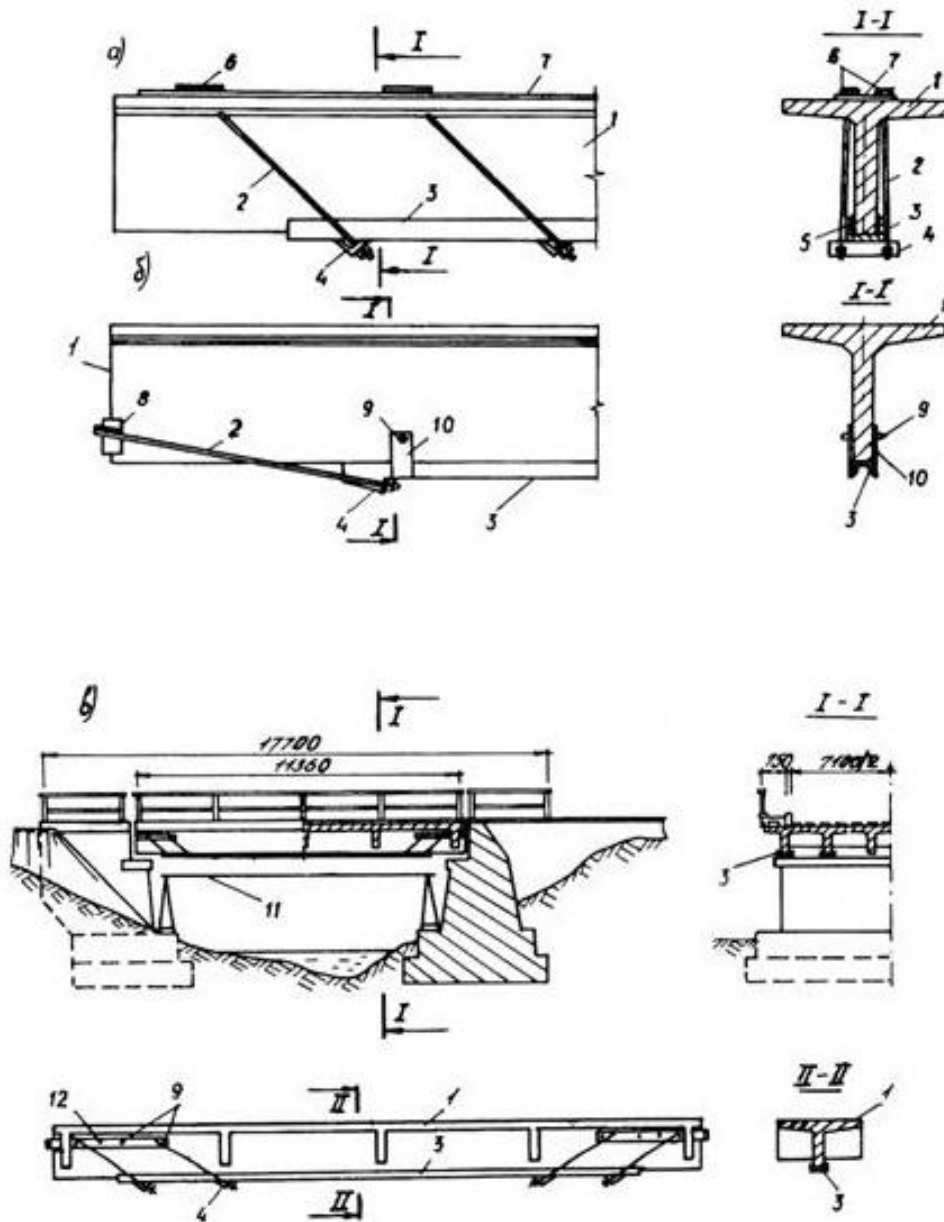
Посилення однопрогонових балок комбінованими металевими каркасами різних конструктивних форм: 1 – балка; 2 – похила тяга; 3 – швелер; 4 – упор; 5 – клейовий шов; 6 – коротуни; 7 – горизонтальний сталевий лист; 8 – торцевий упор; 9 – шпилька; 10 – фасонка; 11 – риштовання; 12 – сталева смуга
